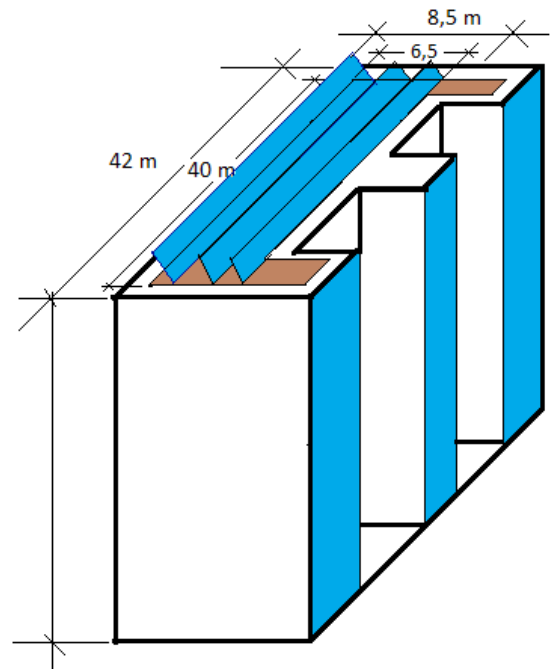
Estructura sugerida de ubicación de los paneles sobre la edificación.
